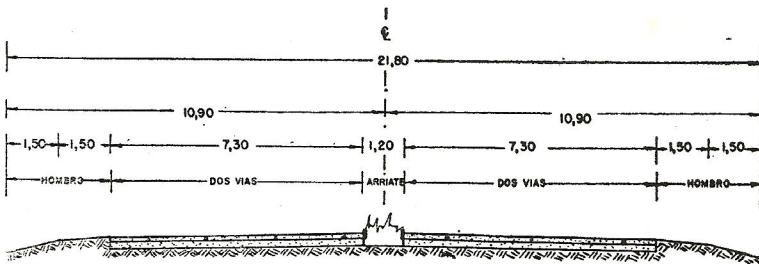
Sección típica de Estación +640 a +2+020 (después del barranco).
